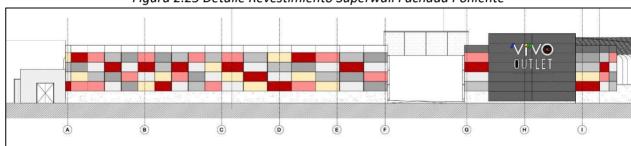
Detalle Revestimiento Superwall Fachada Poniente
